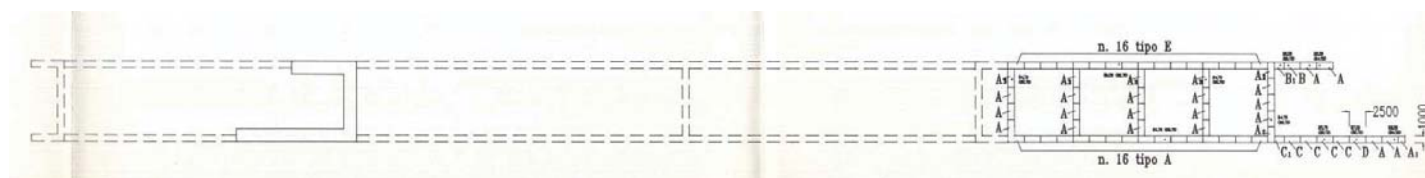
Planimetria delle diaframature di fondazione da progetto 1996 – Tavola 46
